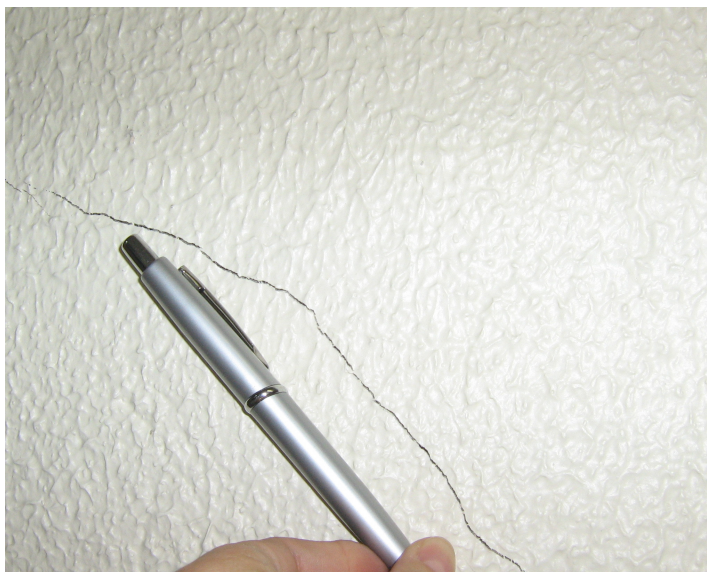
Trinca inclinada no 2º pavimento.
